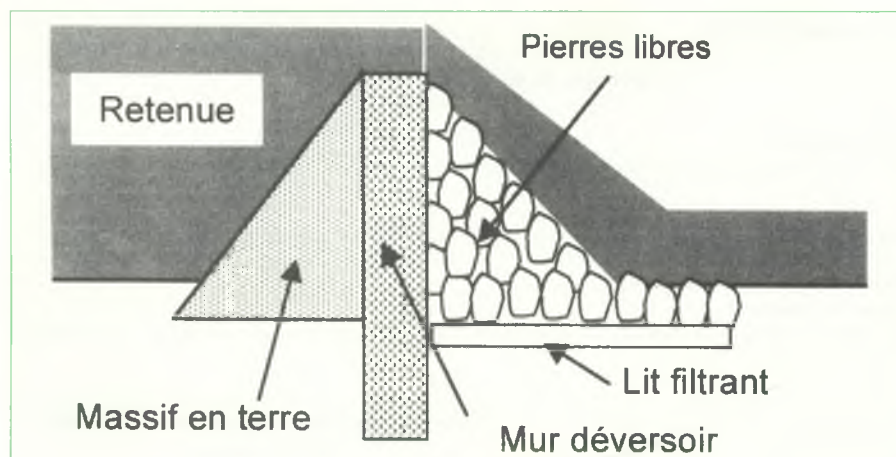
Schéma d'une digue déversante sans tranchée d'étanchéité.
